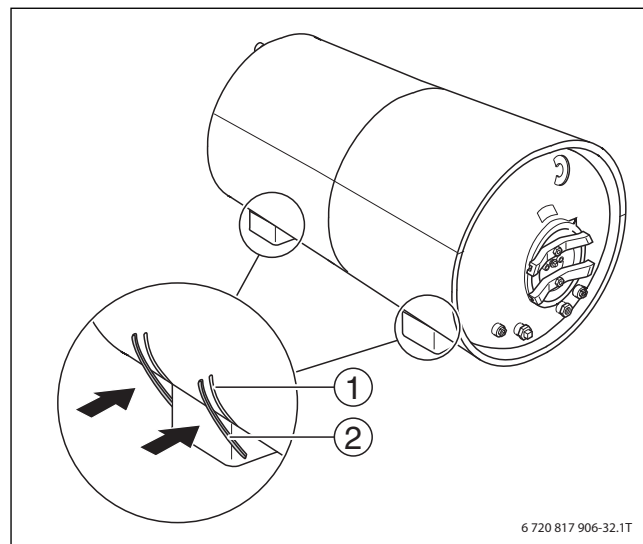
Spojení tepelné izolace závěrnou lištou s hákem
